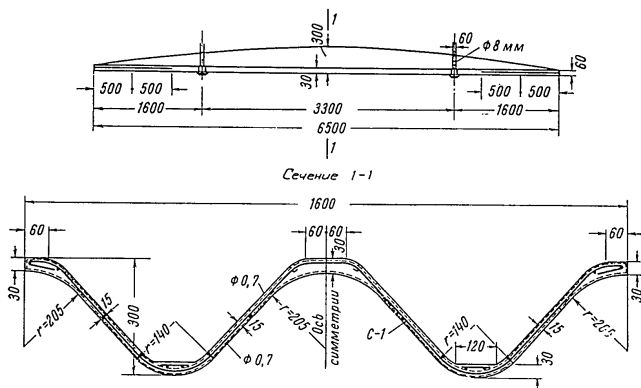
Армоцементная панель кровельного покрытия жилого дома
